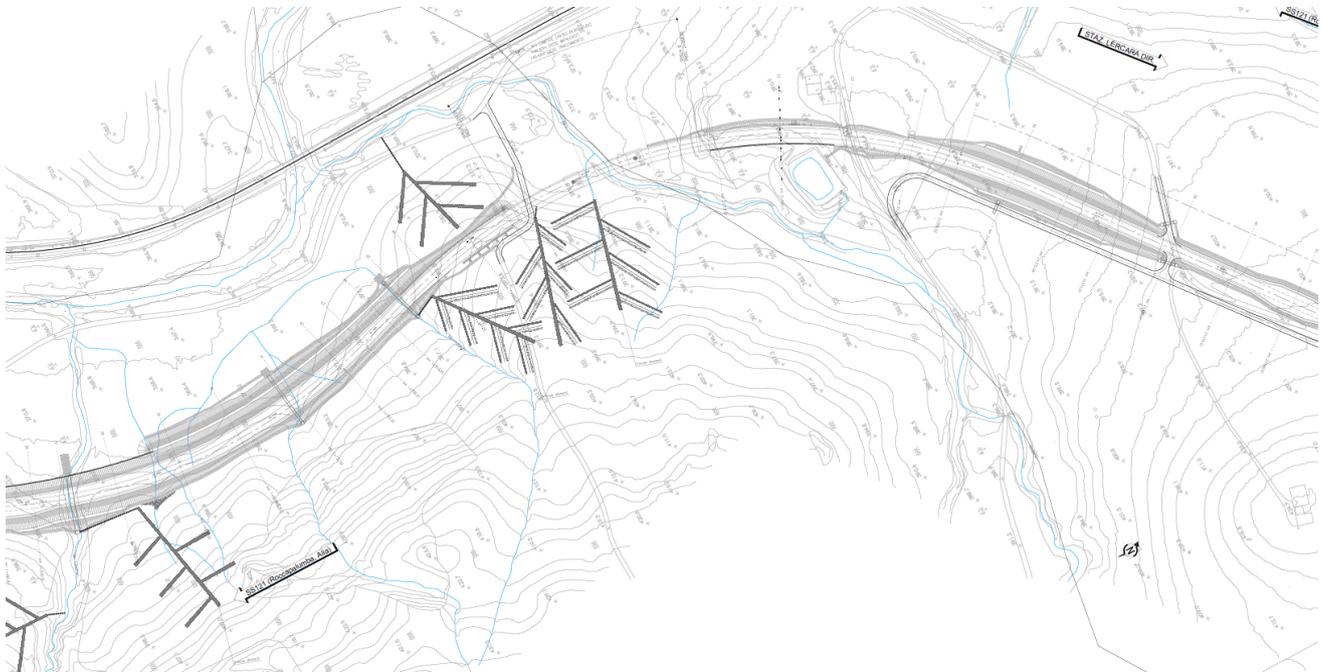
Planimetria di progetto dalla Km 1+535 alla Km 2+462
